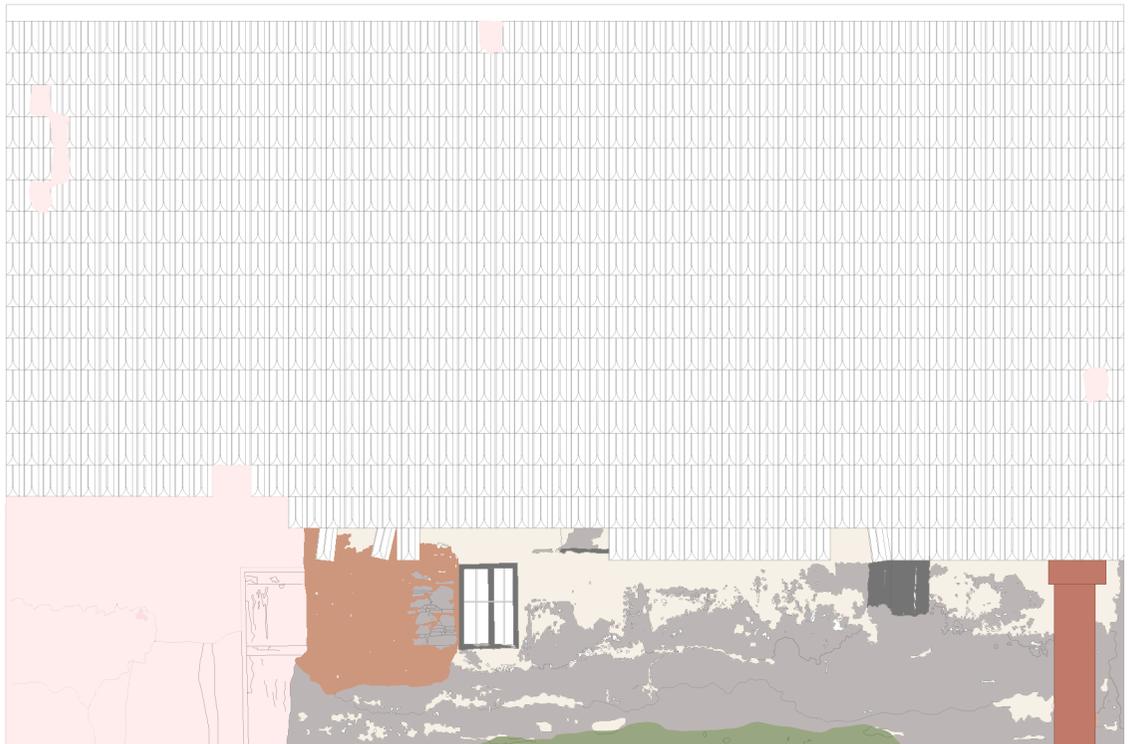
Plano fachada norte patologías. Escala: 1/75. Fuente: Carlos Fuster Aparisi
